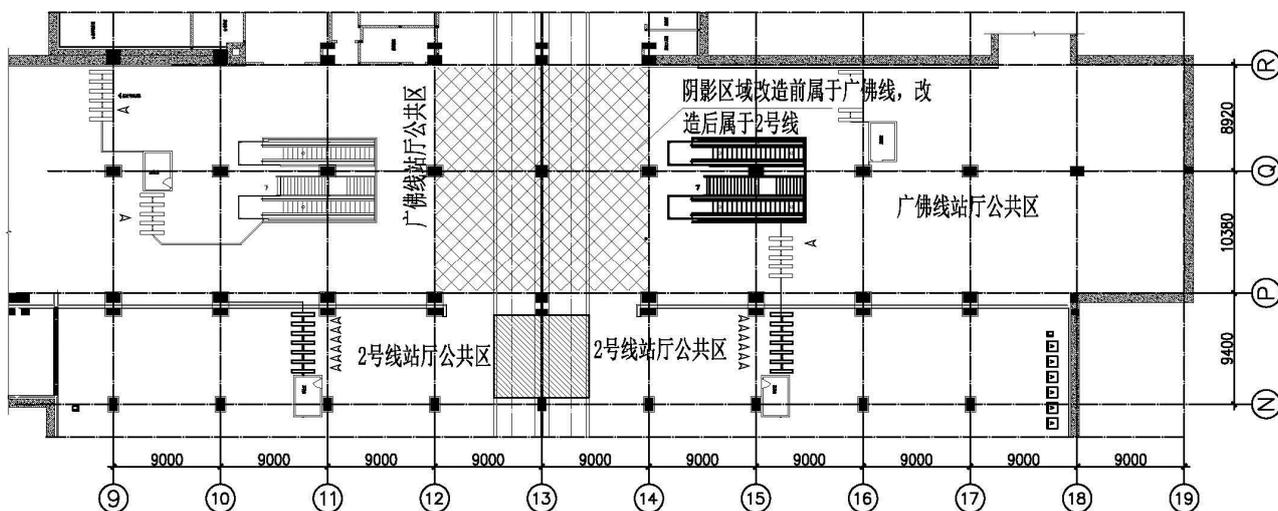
魁奇路站2号线与广佛线换乘交汇区域布置平面图
